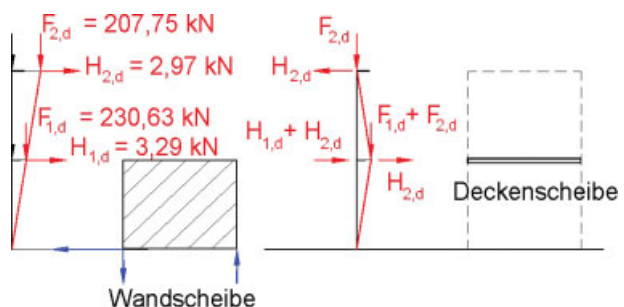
Horizontalkräfte für die Wand- und Deckenscheiben
